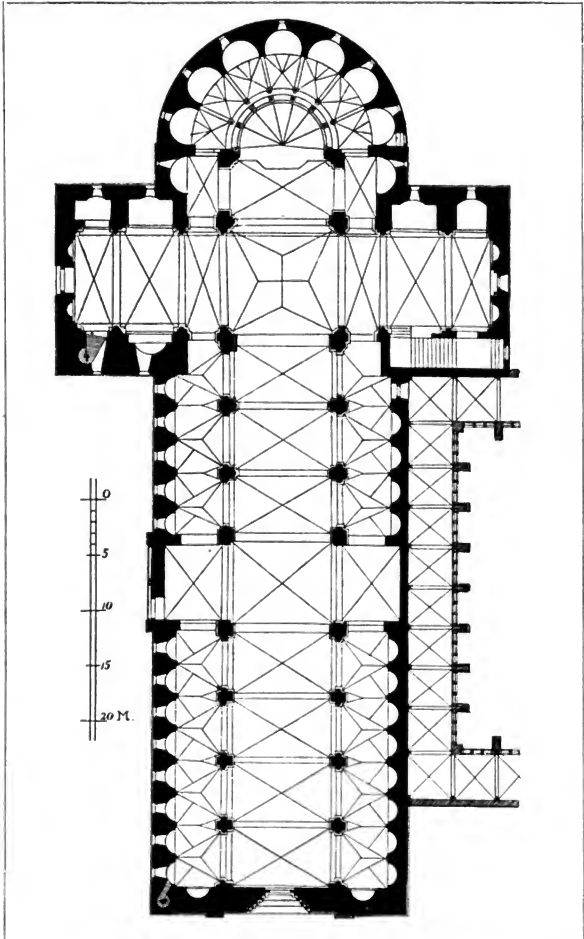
Heisterbach, Abteikirche. Grundriss nach Boisseree.
